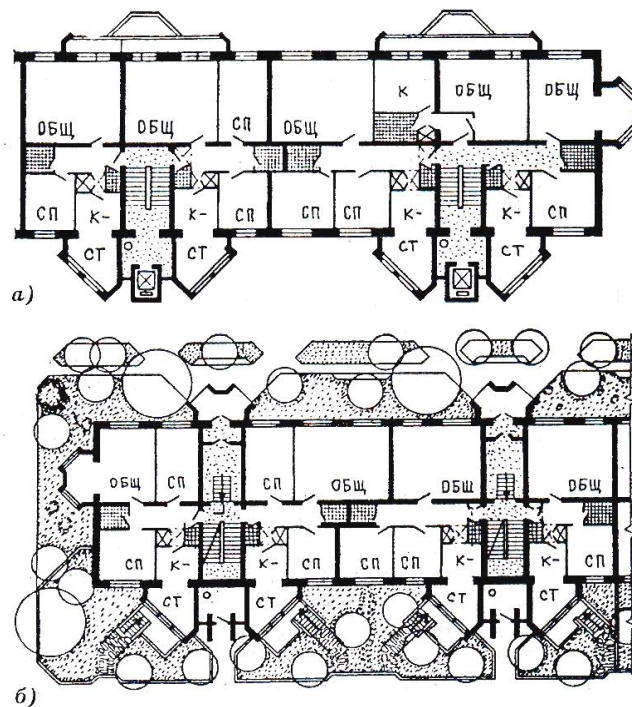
Реконструкция 5-этажного здания с устройством приквартирных садиков и дополнительных входов в квартиры первого этажа
